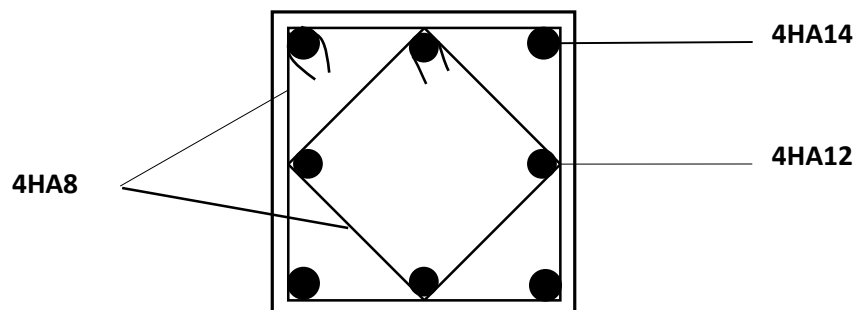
Schéma de ferraillage du poteau 6,7,8,9^{ème} étage.
